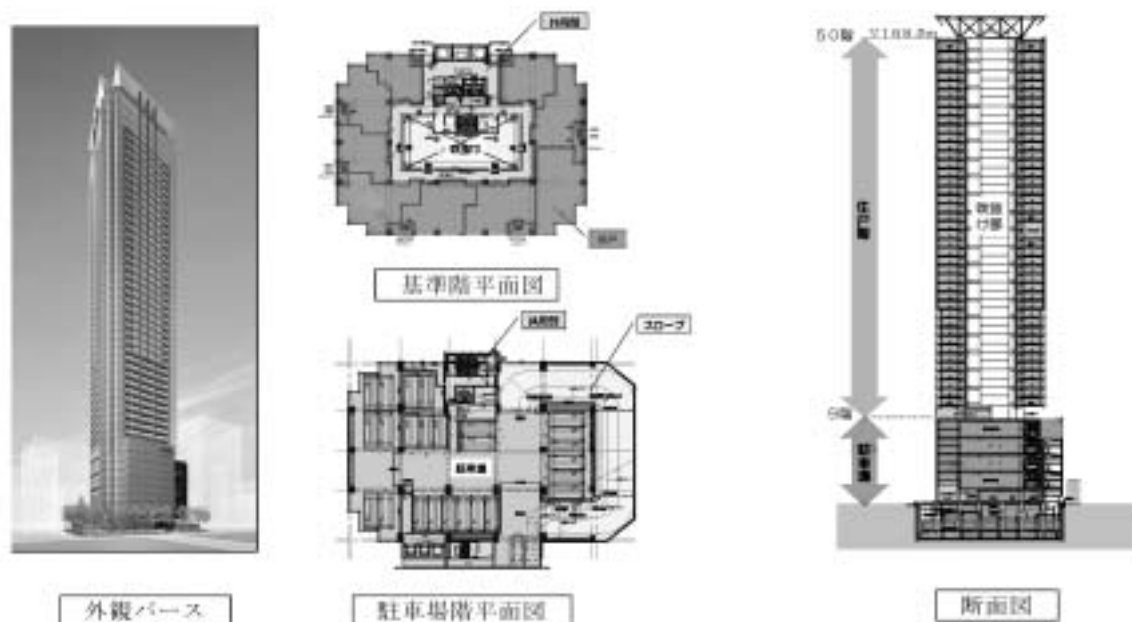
外観パース、基準階平面図、駐車場階平面図、断面図
